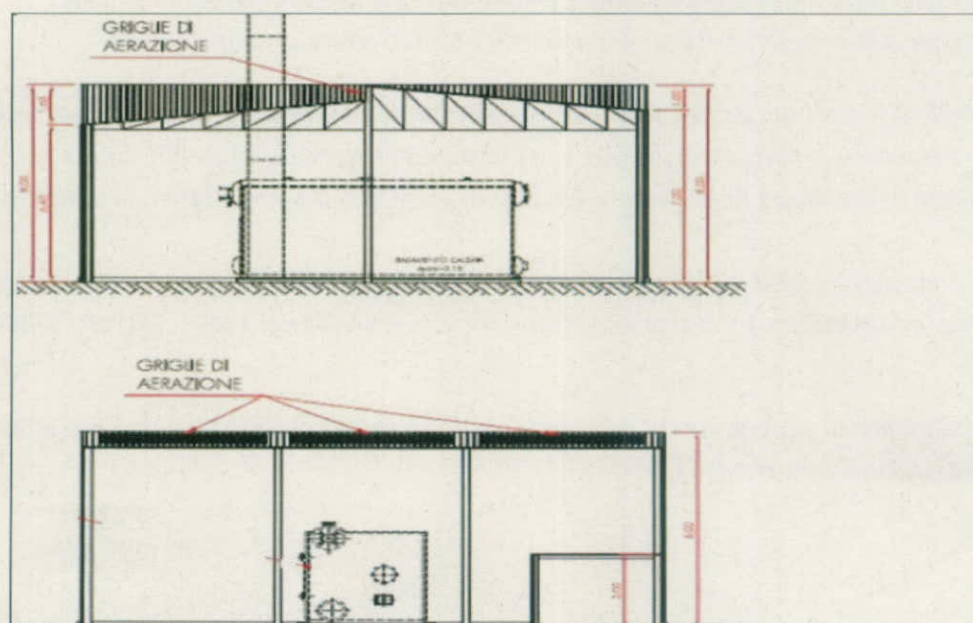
Prospetto edificio - Griglie di areazione superiori
